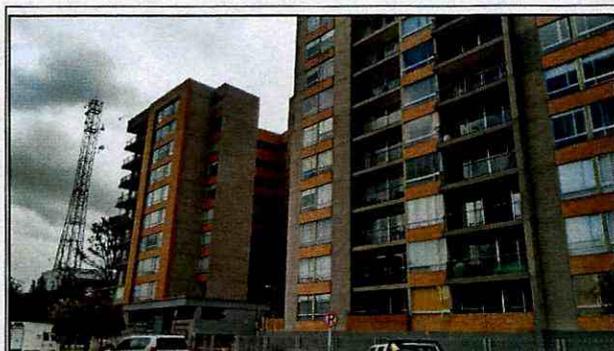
Vista del Condominio Nuevo Salitre PH., ubicado en el predio de la Calle 25G No. 74B-50, en el Sector Catastral Capellanía de la Localidad de Fontibón.
